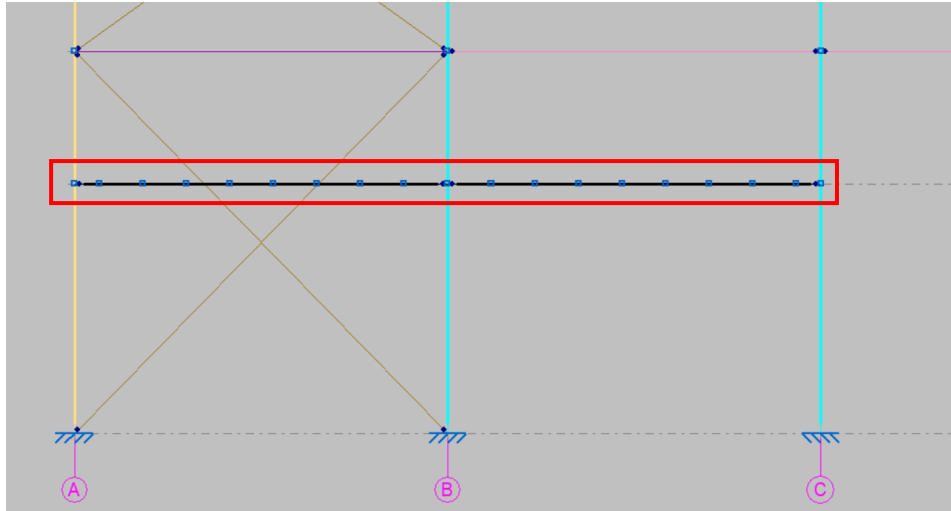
División de pilares en el pórtico lateral. Fuente: CYPE 3D.
